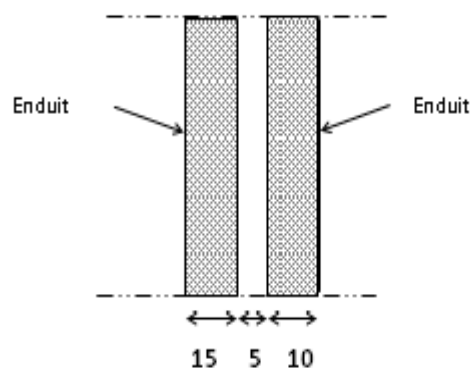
Coupe transversale du mur extérieur (en double cloison)
